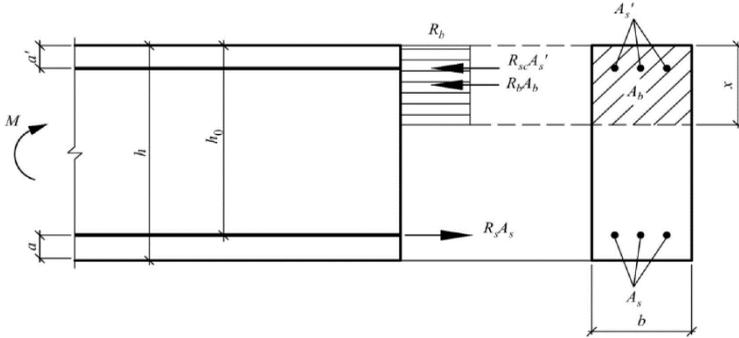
Расчетная схема нормального сечения при изгибе (количество арматурных стержней показано условно)
